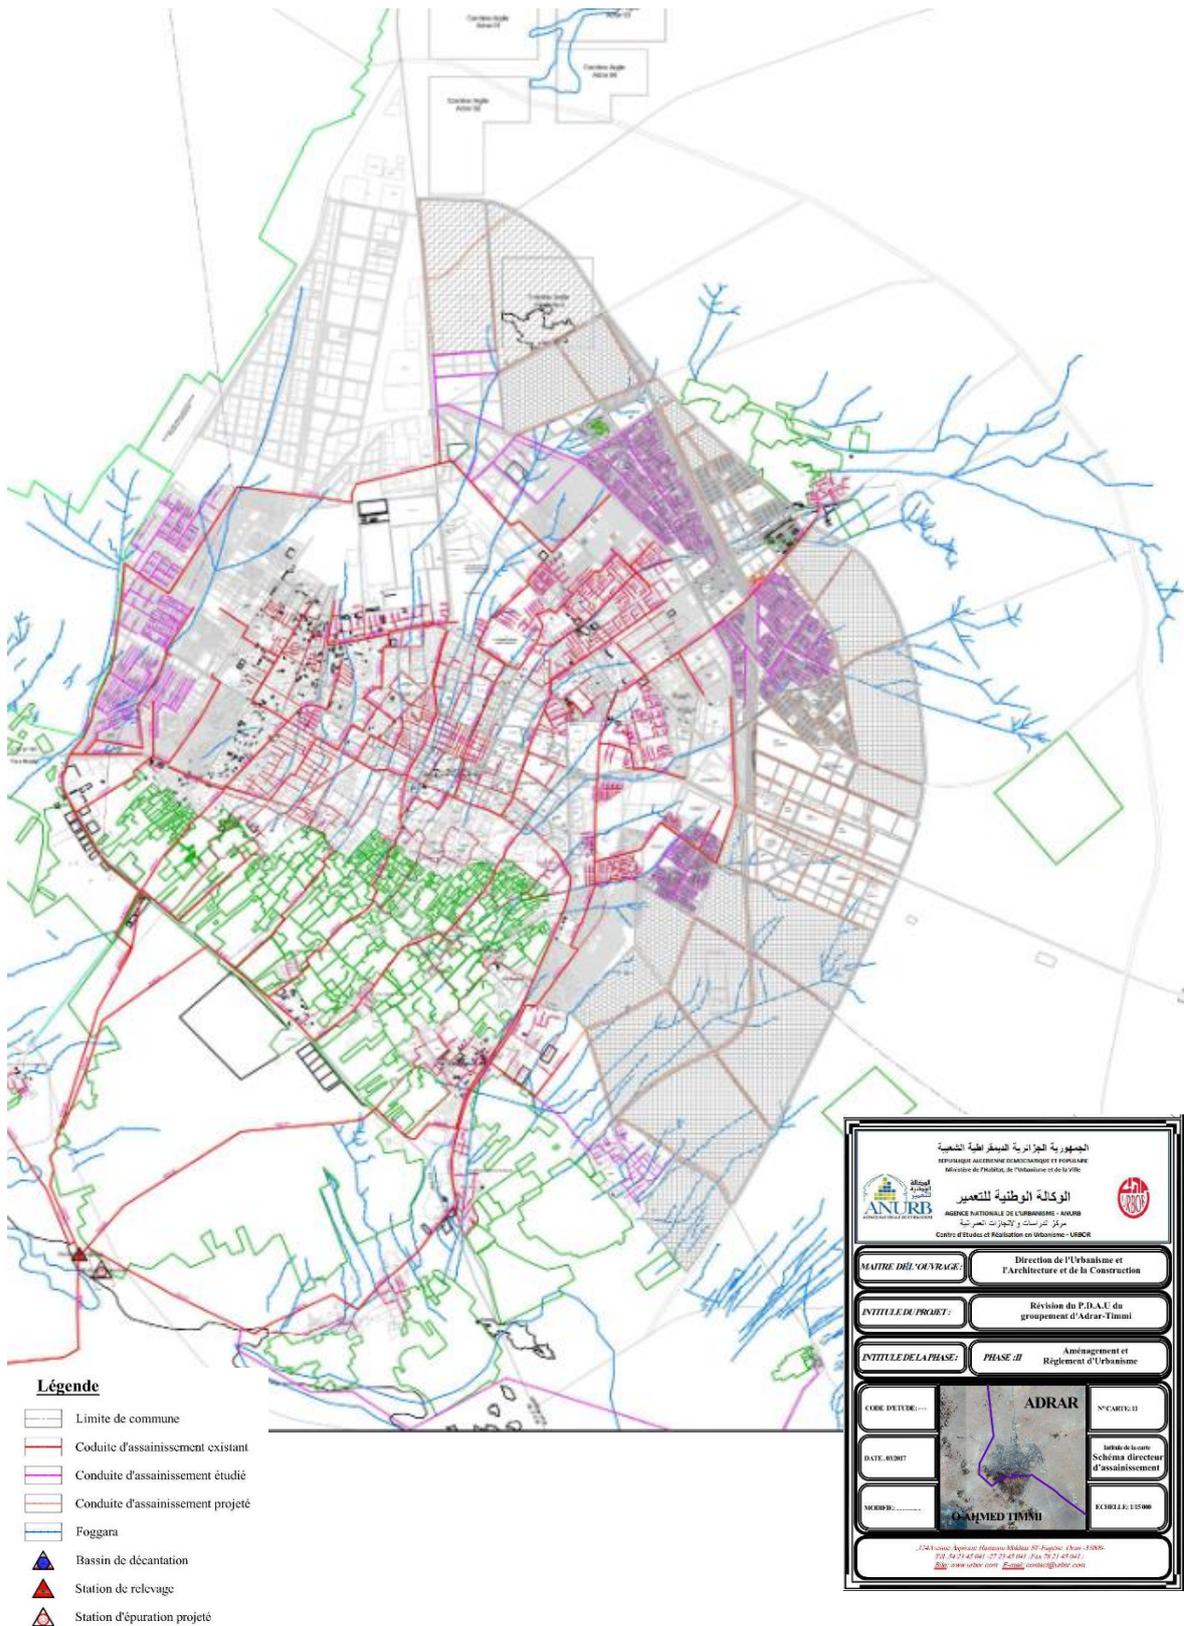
Schéma directeur d'assainissement, Source : la direction d'urbanisme et l'architecture et la construction de la wilaya adrar
